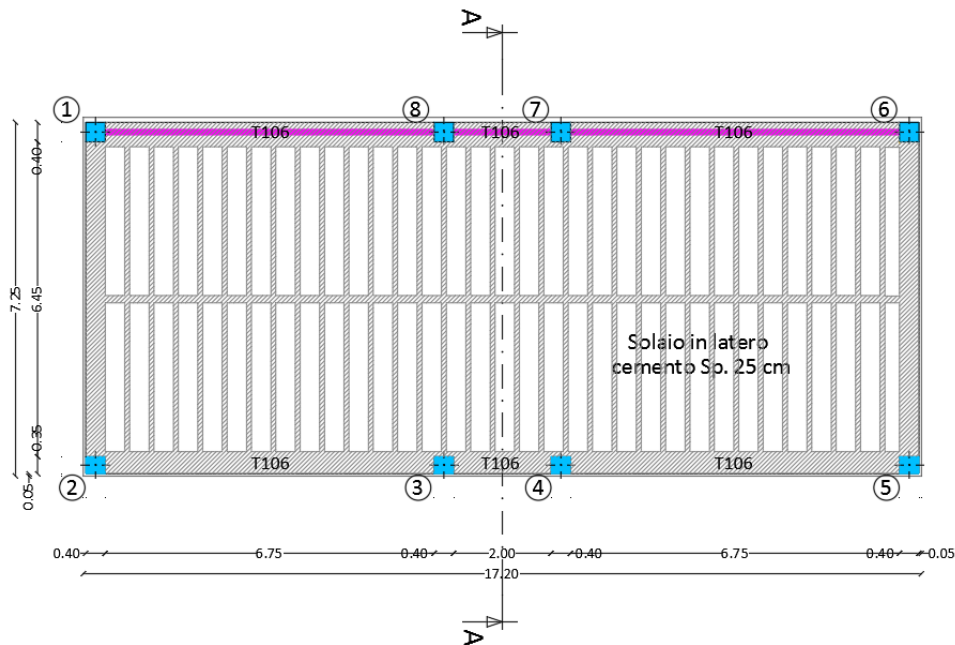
Planimetria Piano Terra del corpo Q con indicazione in colore magenta dei rinforzi in acciaio.
